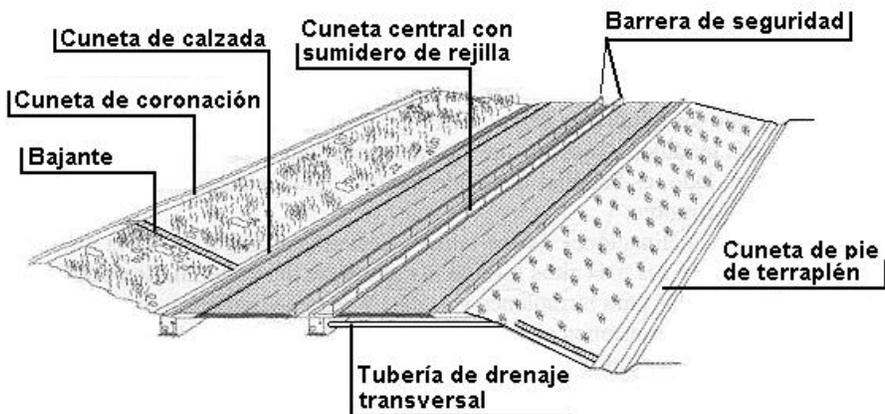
c: Sección Transversal en "Media Ladera" en Vía de Calzada Dividida.
